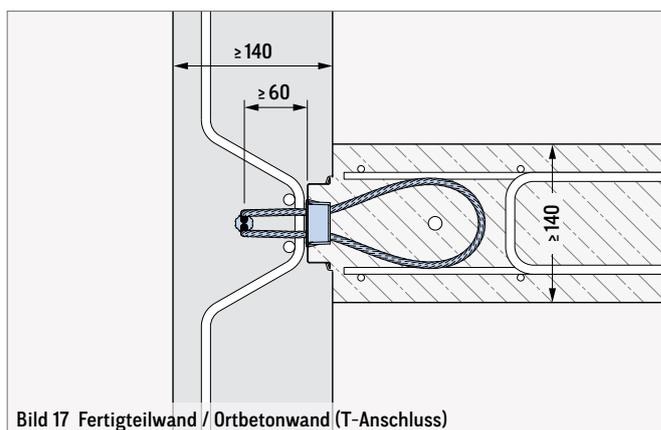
Fertigteilwand / Ortbetonwand (T-Anschluss)
